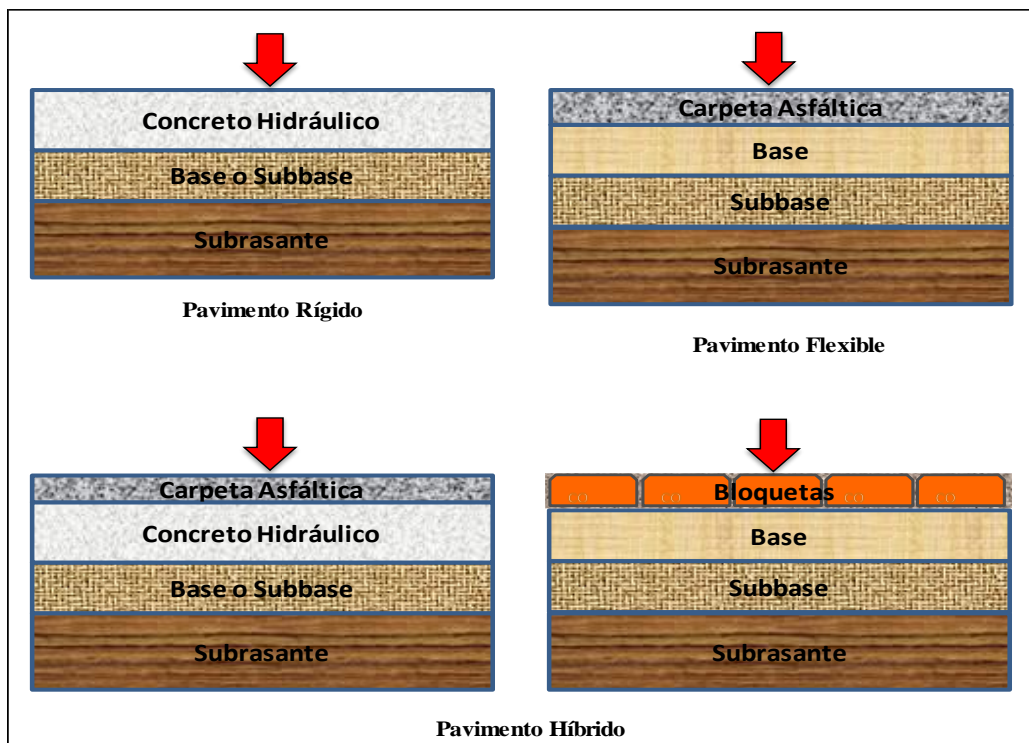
Esquema de paquete estructural de los pavimentos flexibles, rígidos e híbridos.
